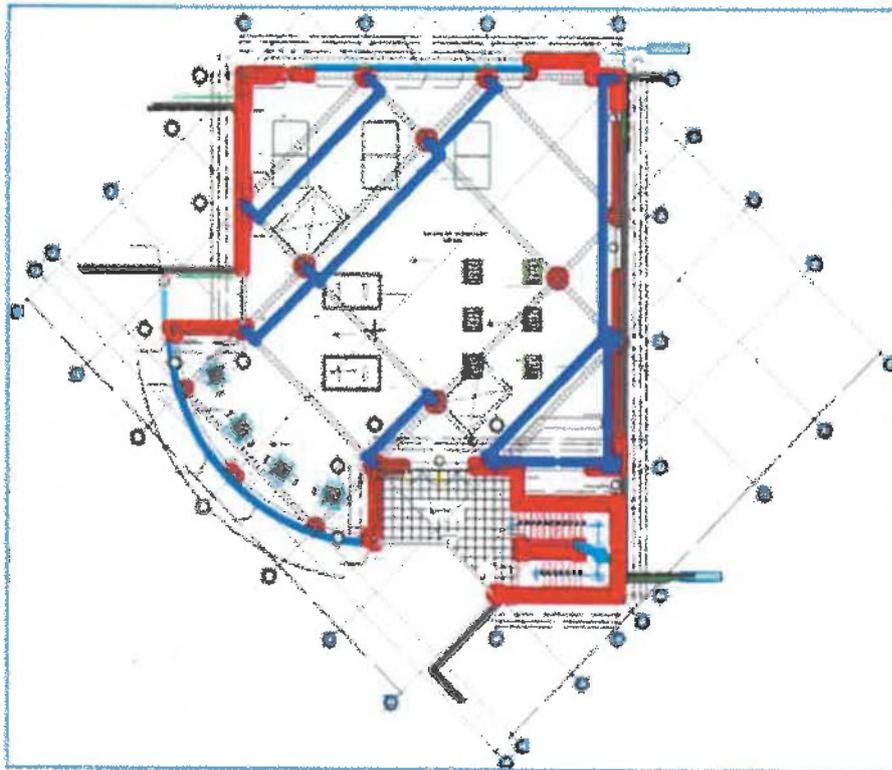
Plano de distribución arquitectónica del 1er nivel.
